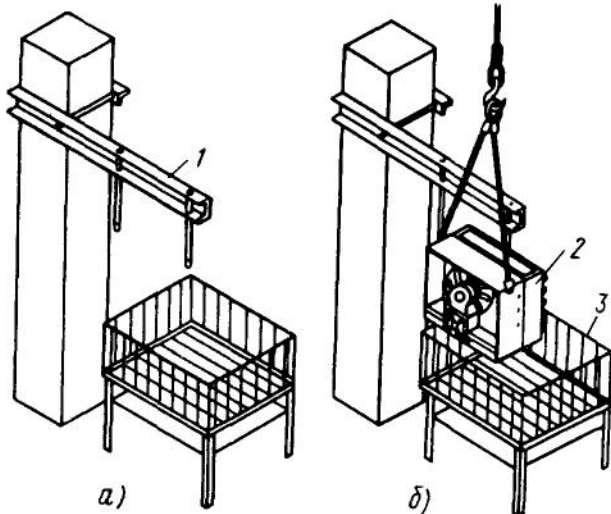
Монтаж подвесного агрегата: а — установка кронштейнов, б — установка агрегата; 1 — кронштейн, 2 — агрегат, 3 — монтажная вышка
